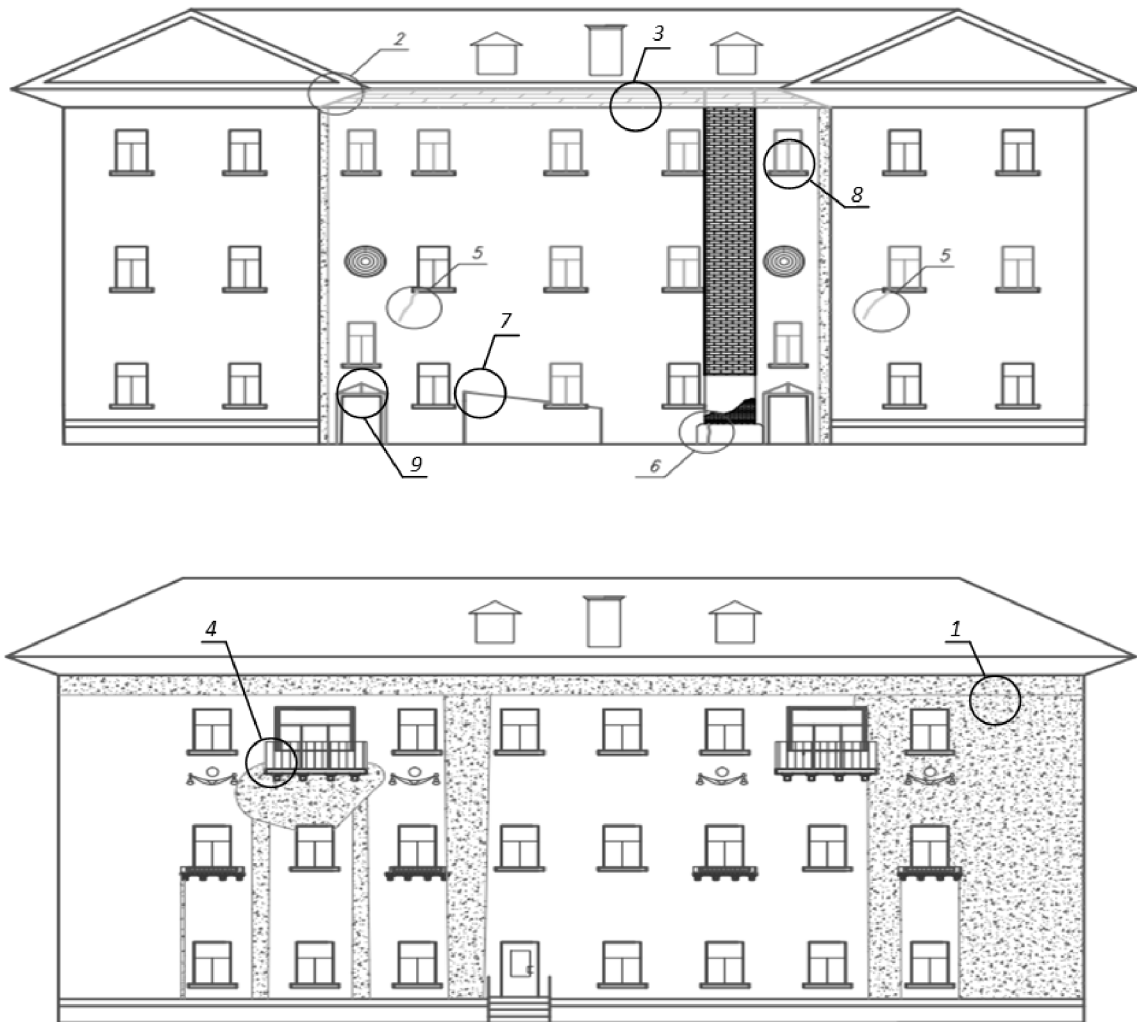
Дефекты фасадов: 1 – отслоение и отпадение штукатурки стен, выветривание швов, ослабление кирпичной кладки, выпадение отдельных кирпичей; 2 – разрушение защитного слоя; 3 – увлажнение поверхности стен, плесень; 4 – оголение несущей конструкции балконов; 5 – трещины от углов оконных проемов; 6 – трещины в цокольной части здания; 7 – кровельный материал входа в подвал требует замены; 8 – старые деревянные рамы; 9 – старых козырьков, неподходящий к фасаду
